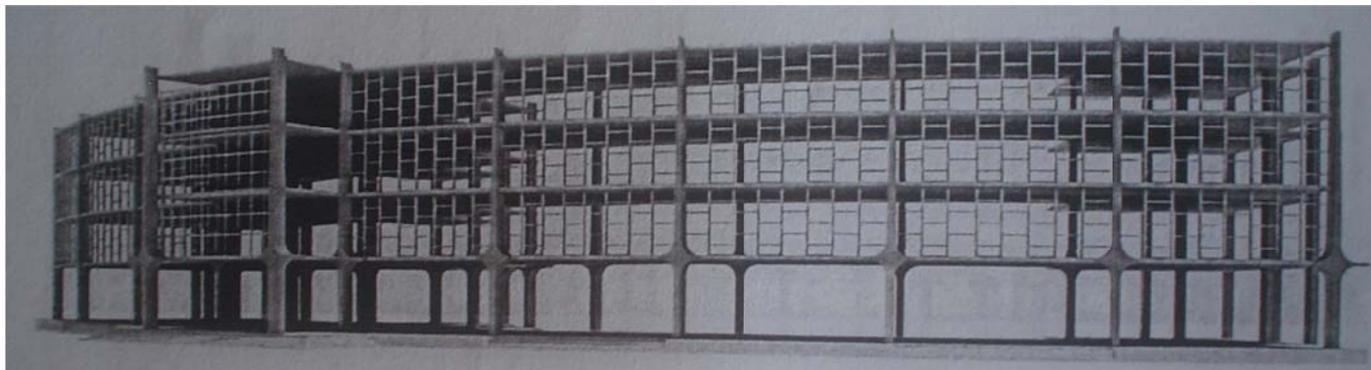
Alzado de la estructura del edificio. Fuente: Tesis Lata Guamán, Oswaldo. ALAMIRO GONZÁLEZ. OBRAS Y PROYECTOS ENTRE 1960-1970
